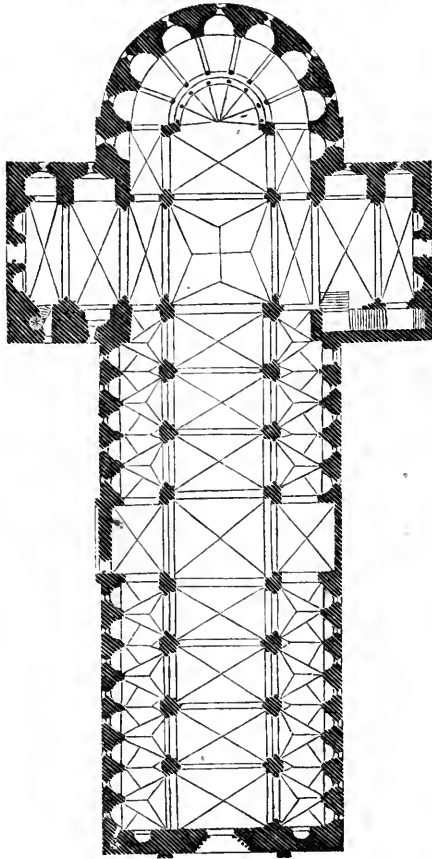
Kirche zu Heisterbach. Grundriss.
